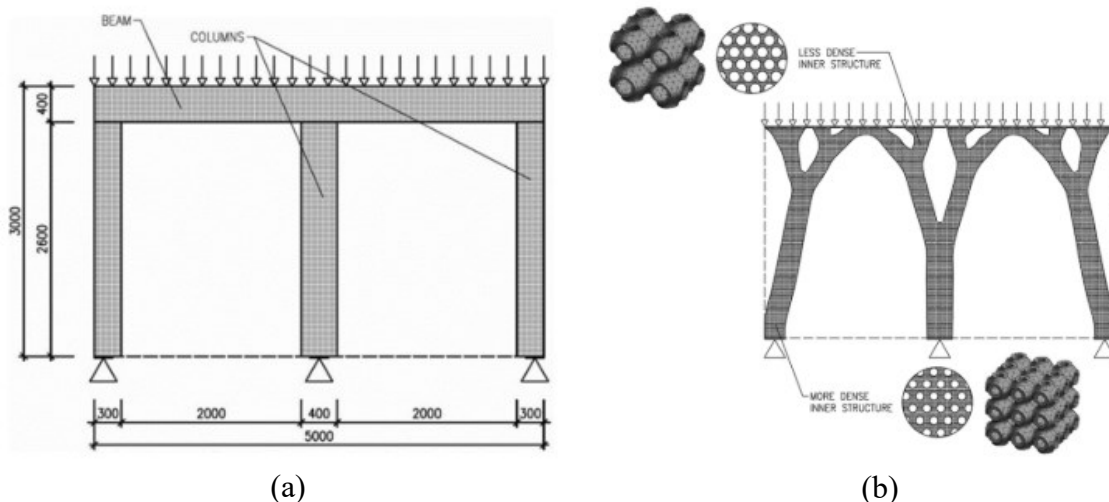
Elementy z betonu: (a) Schéma silového působení, (b) 3D tisk elementů [35]
